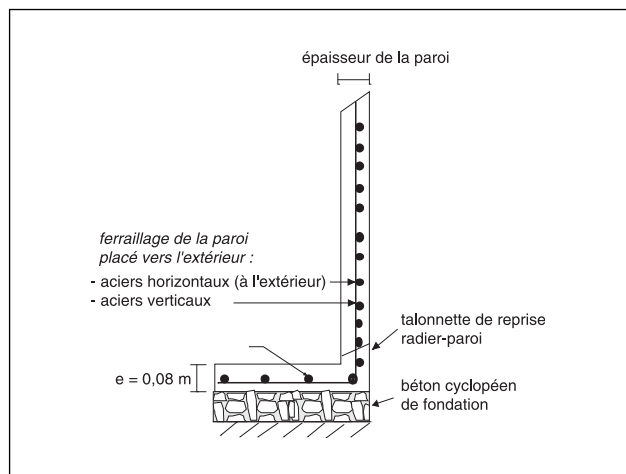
Ferrailage des parois d'un petit réservoir rectangulaire, de longueur de paroi inférieure à 2 m, avec $a_{\text{mini}} = 40$ cm (vue en coupe verticale).
